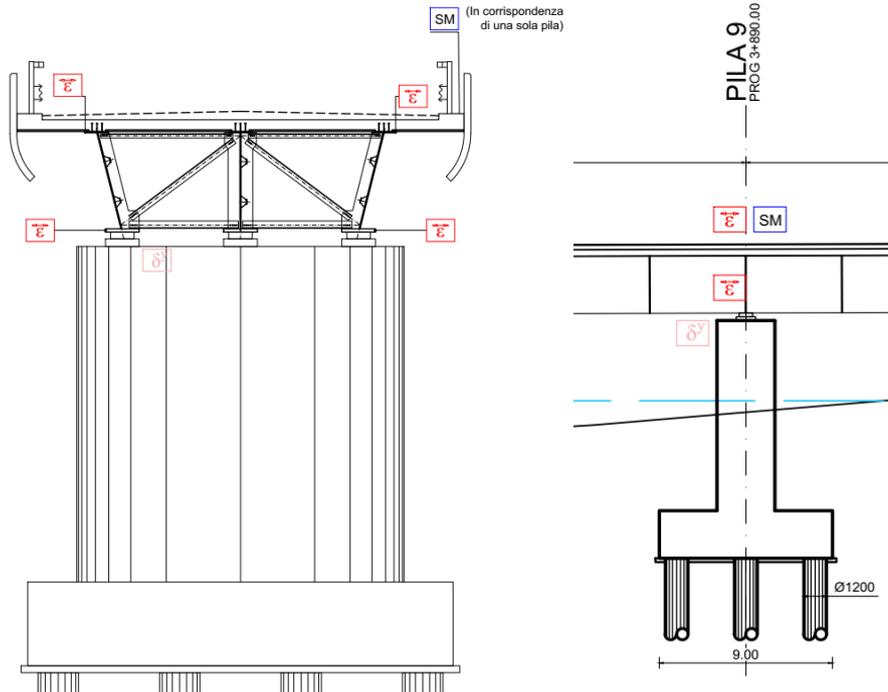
Ubicazione sensori su pile (sezioni e fondazione viadotto Tevere)
